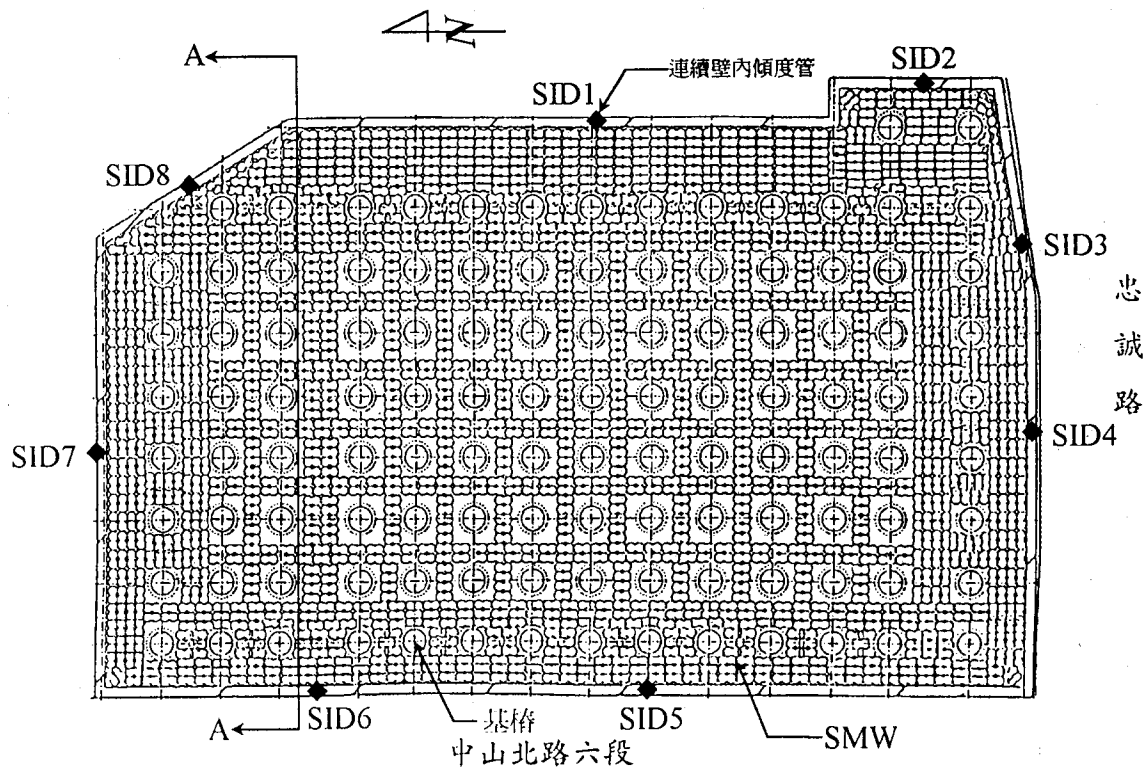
A基地深層混合地盤改良平面及剖面示意圖
